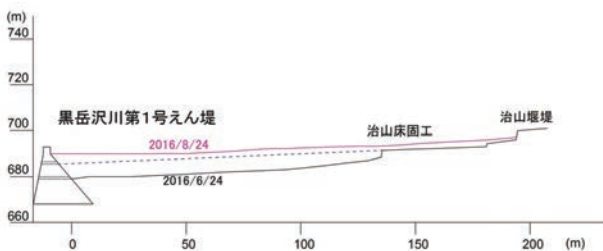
黒岳沢川第1号えん堤堆砂縦断面図
